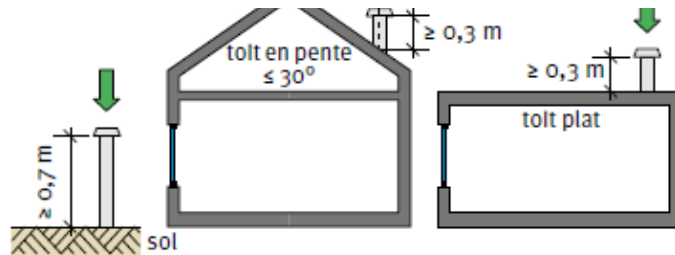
Hauteur minimale des prises d'air placées au sol (à gauche) et sur une toiture dont la pente n'est pas supérieure à 30° (à droite).
